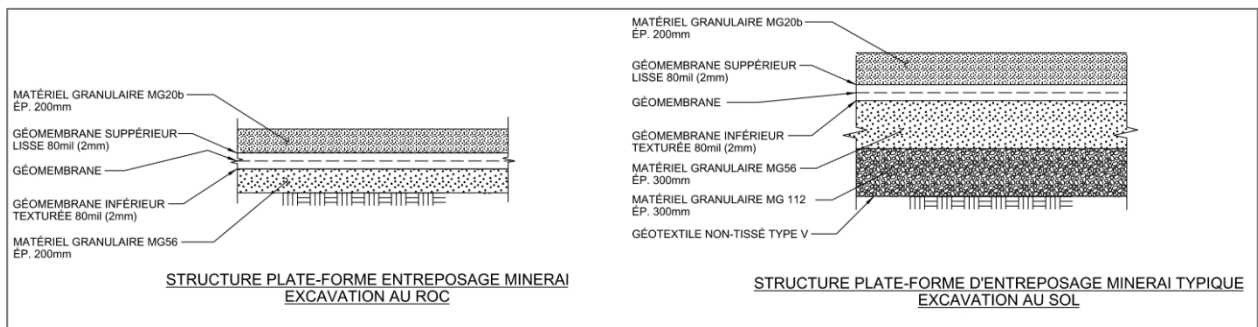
Détail de la fondation proposée pour la plateforme de minerai brut au site du concentrateur
